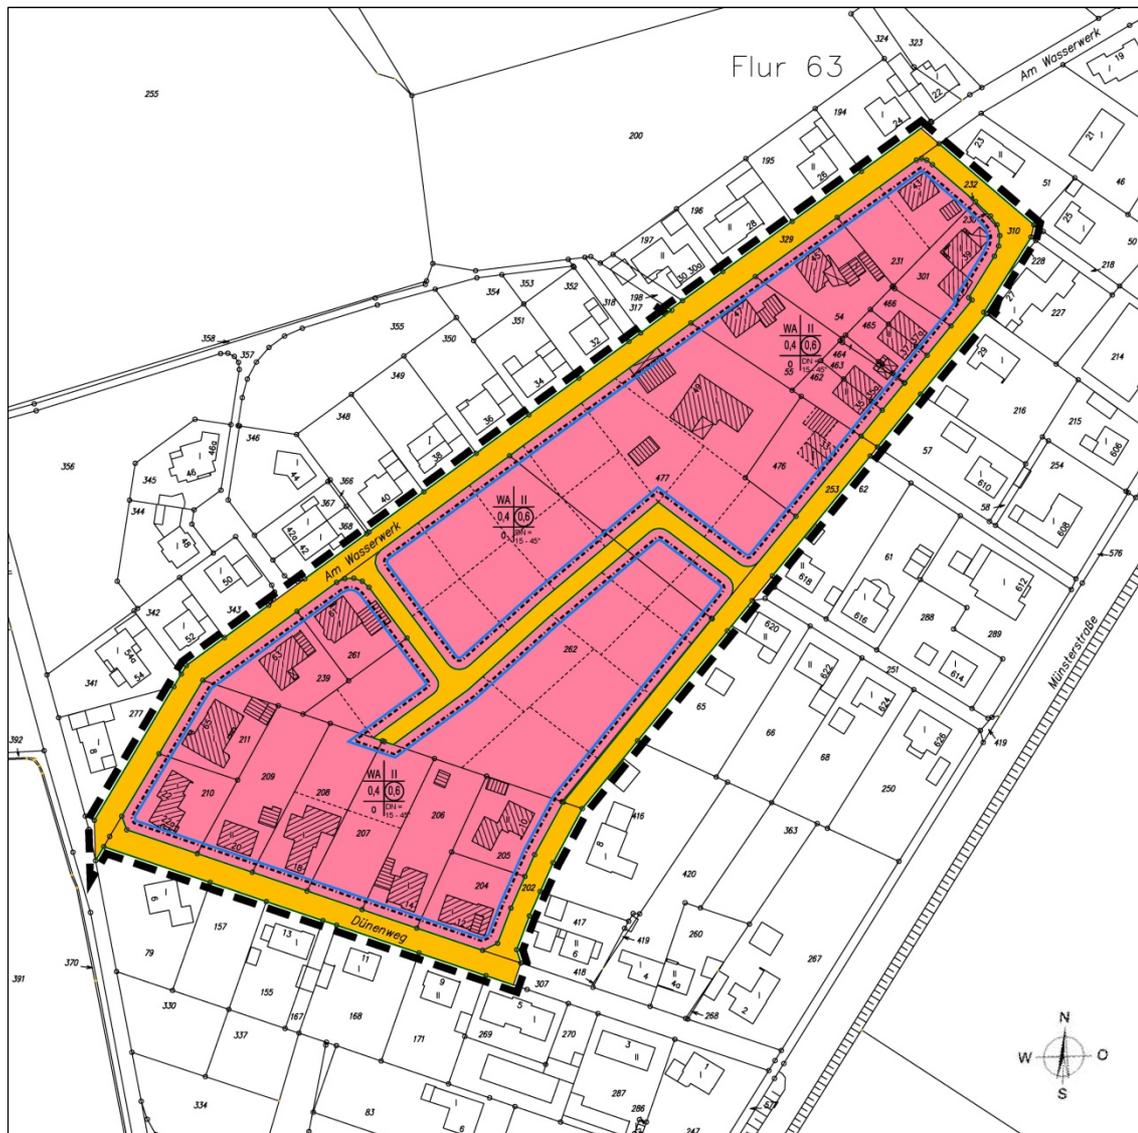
Entwurf der Planzeichnung zum Bebauungsplan (Entwurf)
